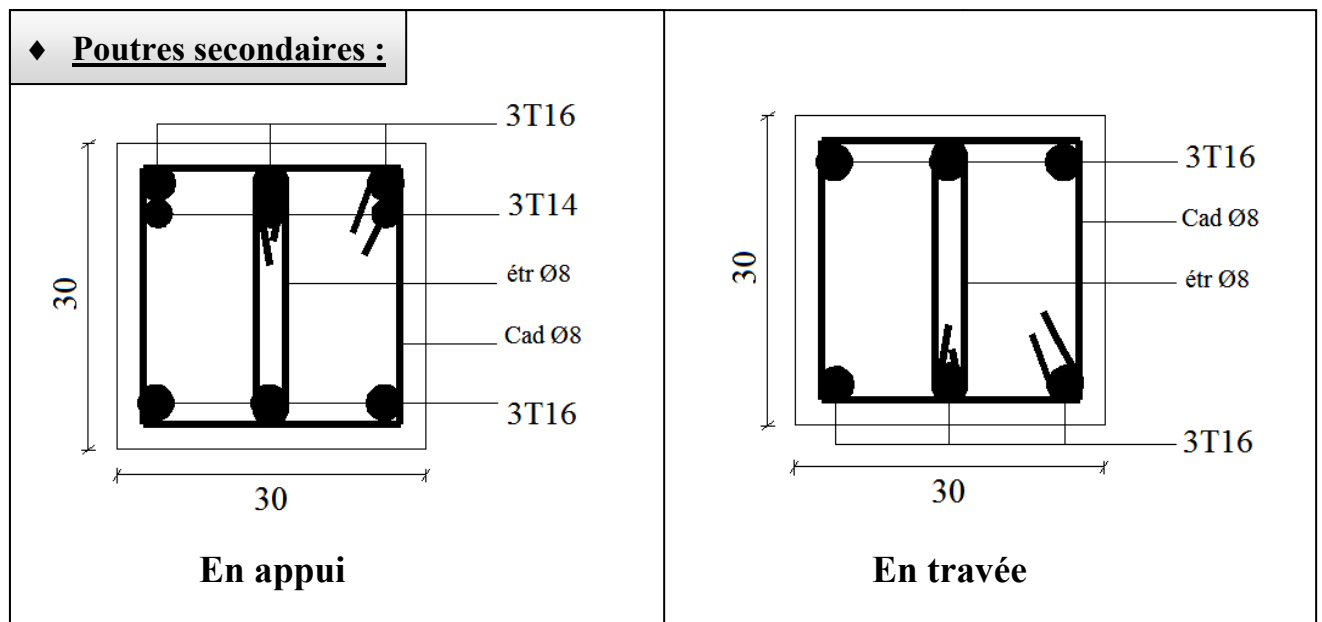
schéma de ferrailage des poutres secondaires.
